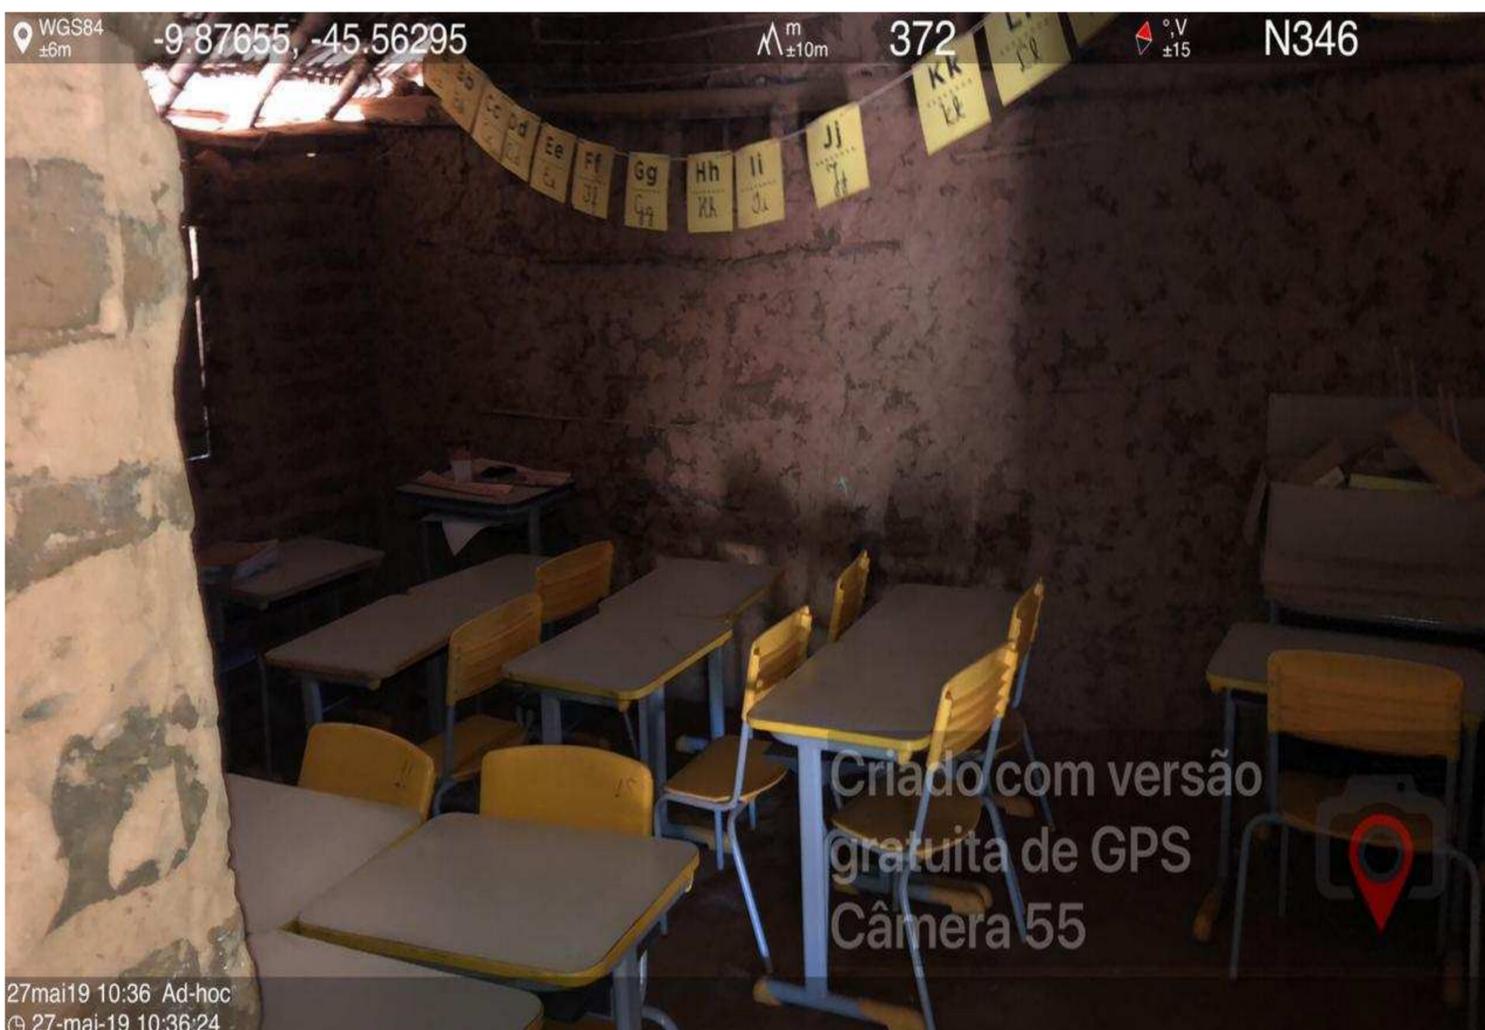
Barreiras do Piauí – Escola Municipal João Caciano
